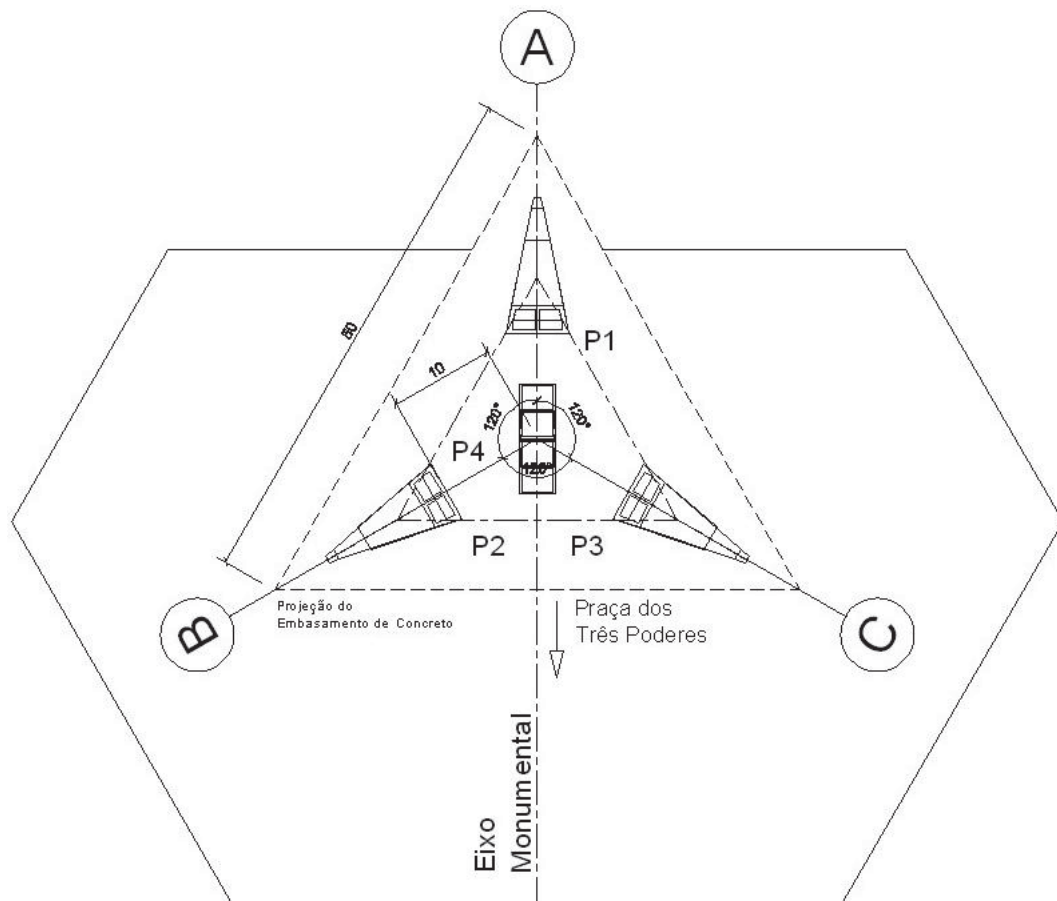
Locação dos Pilares (Fonte: Autor - Cotas em “m”)
